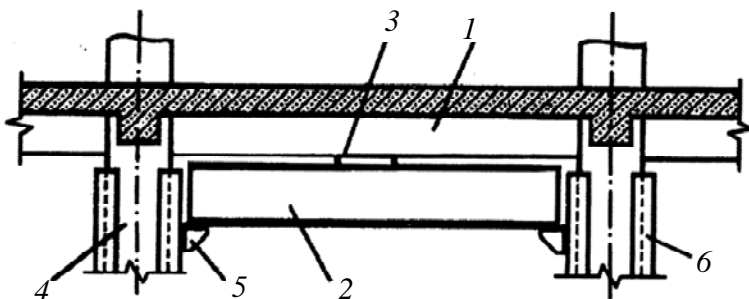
Усиление частичным разгрузением конструкции (дополнительной упругой опорой – балкой на кронштейнах):
